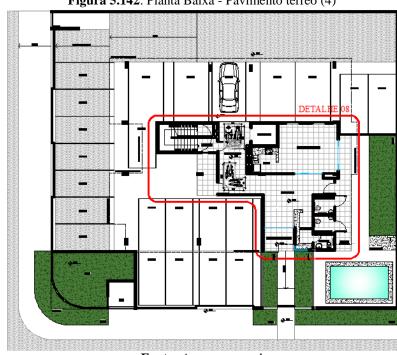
Planta Baixa - Pavimento térreo (4)
